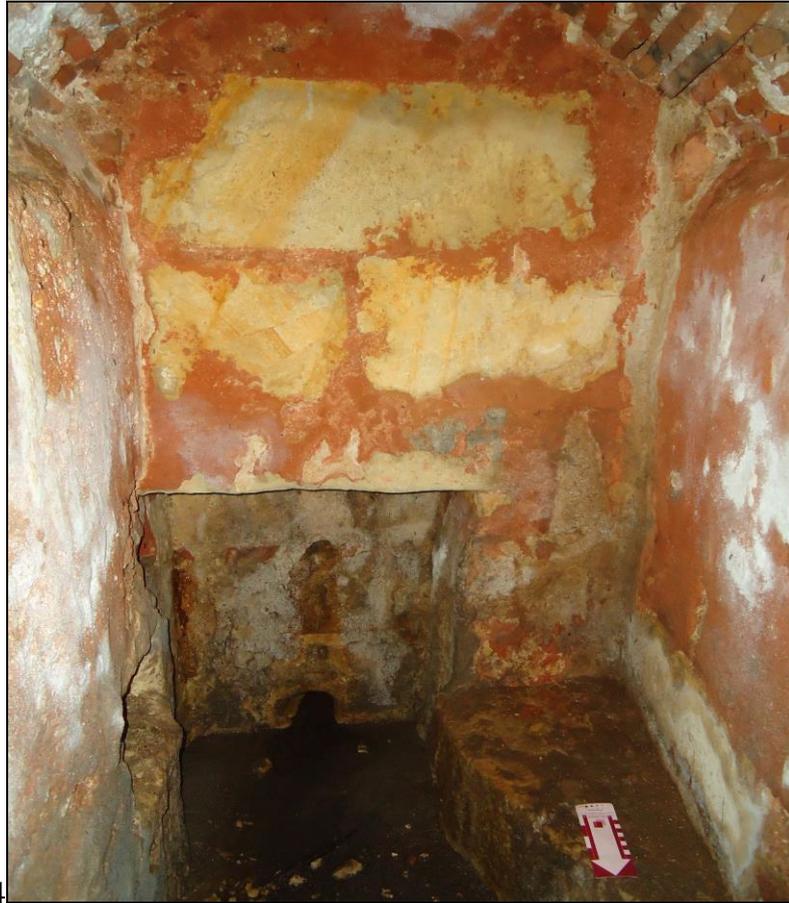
Vista da Boca do Túnel da Micha durante intervenção. Ponto de ligação do túnel com o dreno que sai da cisterna do Claustro da Micha.
